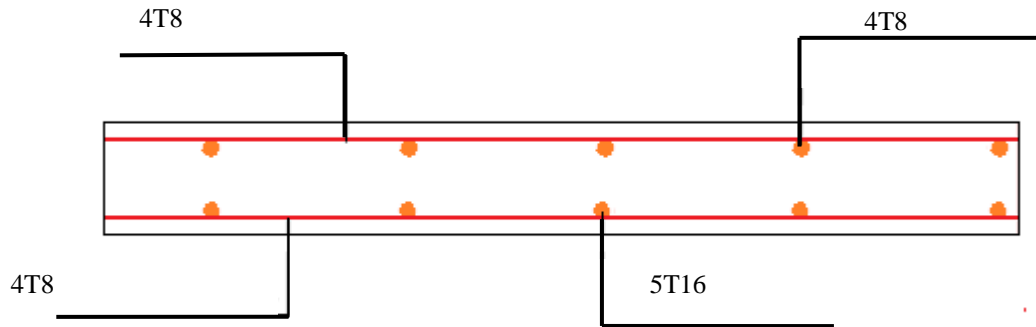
Schéma de ferrailage de la dalle pleine sur 3 appuis.
